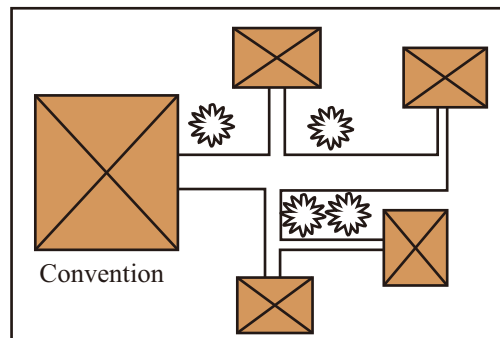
Bentuk Bangunan Cottage Menyebar
